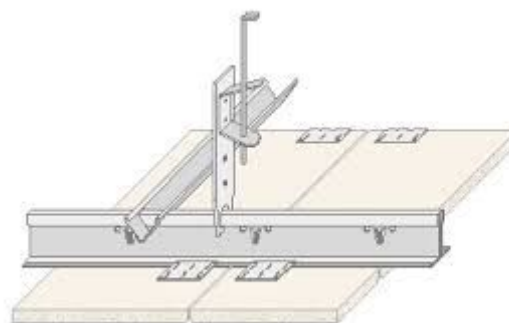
Falso techo detalle (Fuente: Generador de precios)
